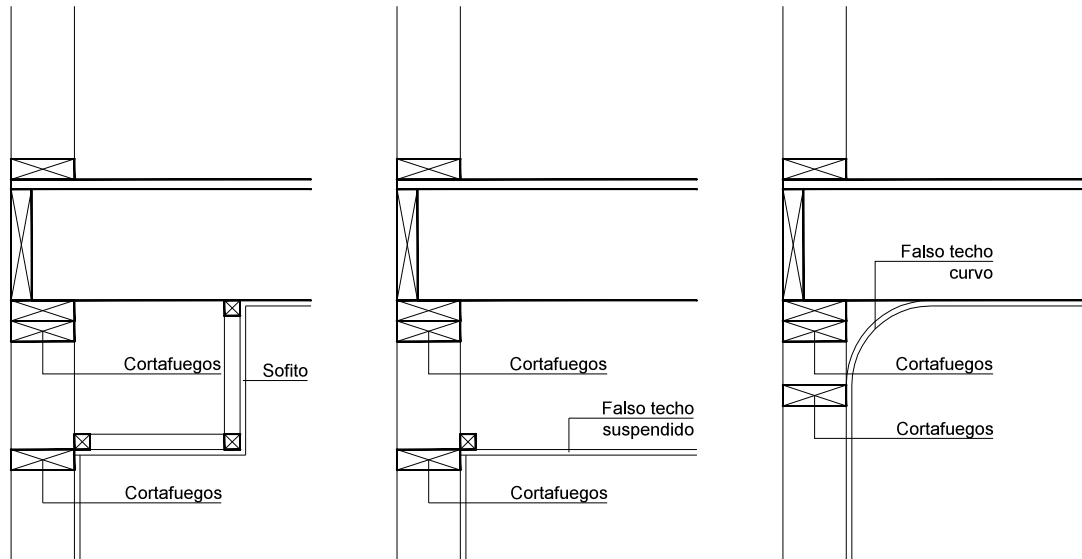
Elementos cortafuegos en los encuentros entre el falso techo y el muro
